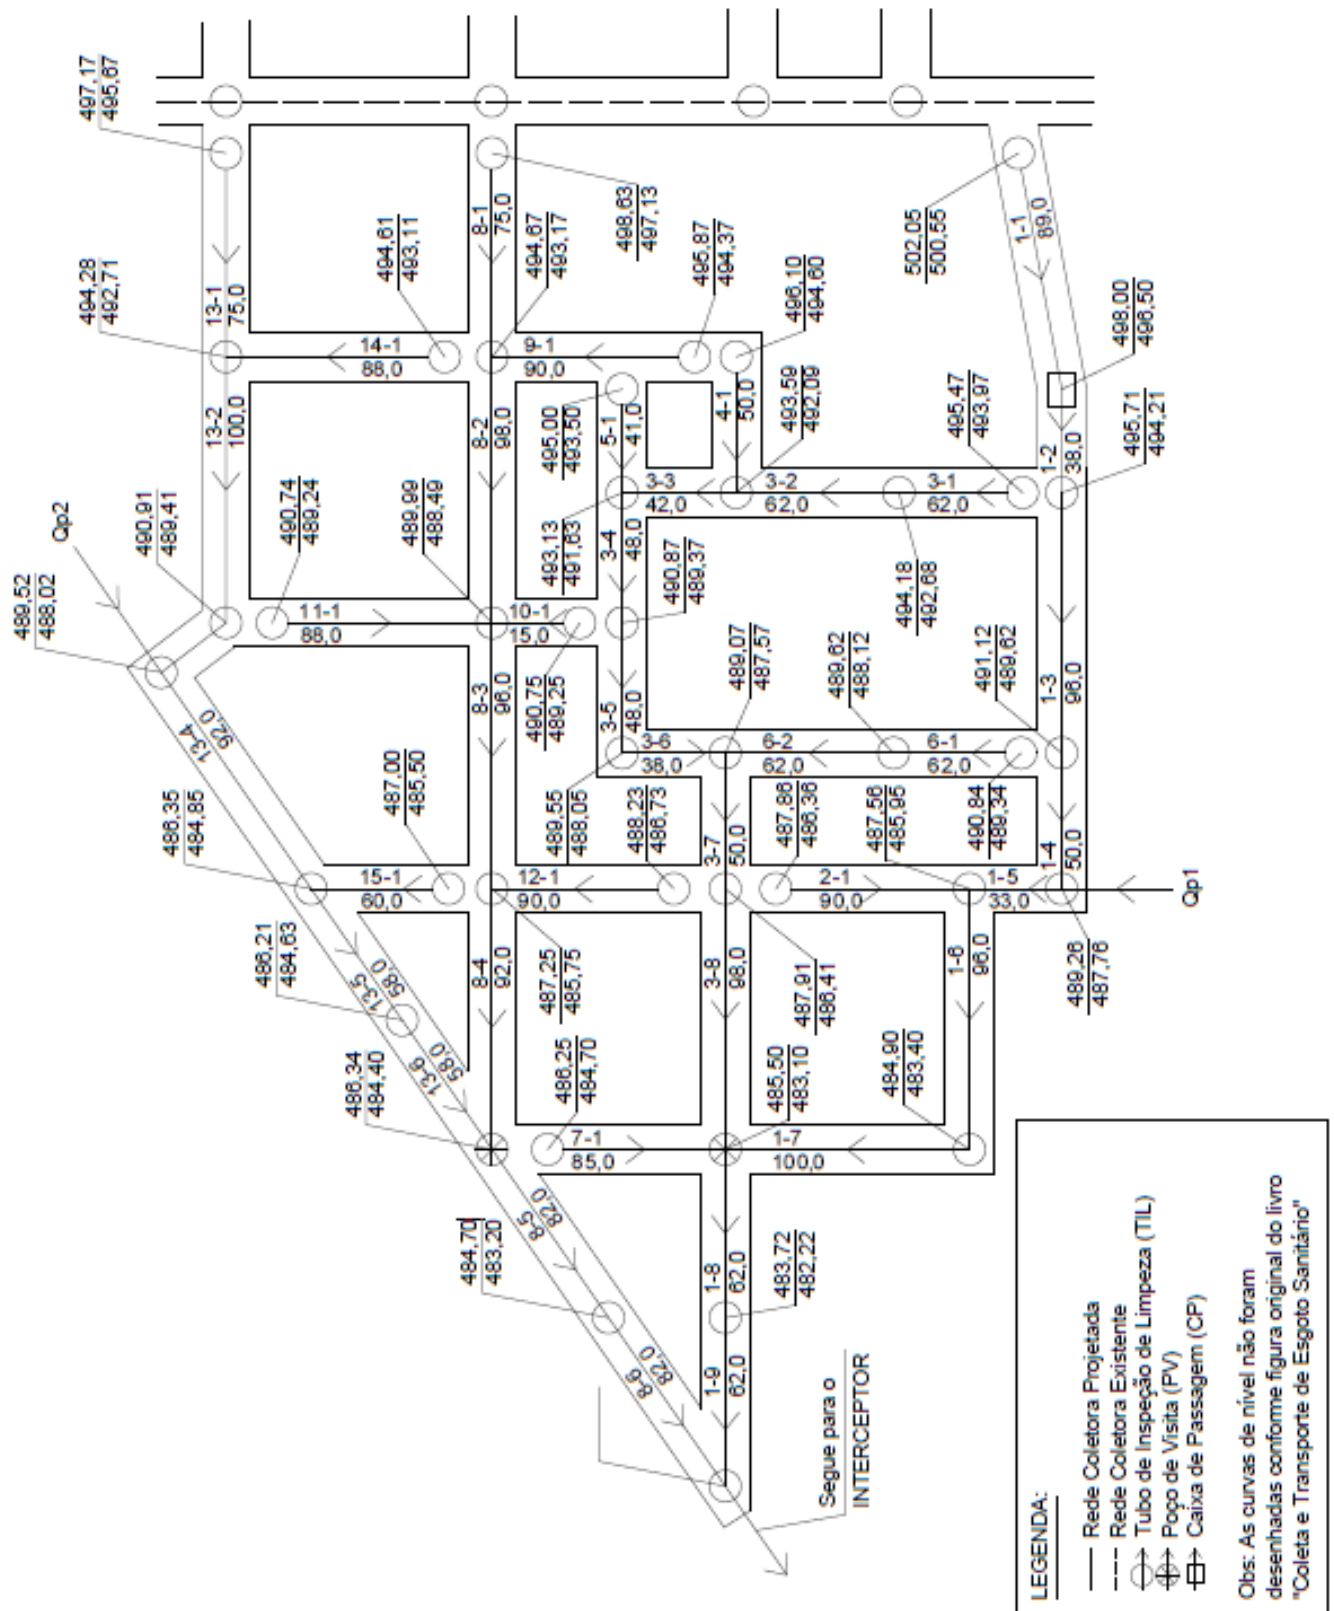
Planta para dimensionamento de uma rede coletora de esgoto (Alem Sobrinho e Tsutiya, 2000)
